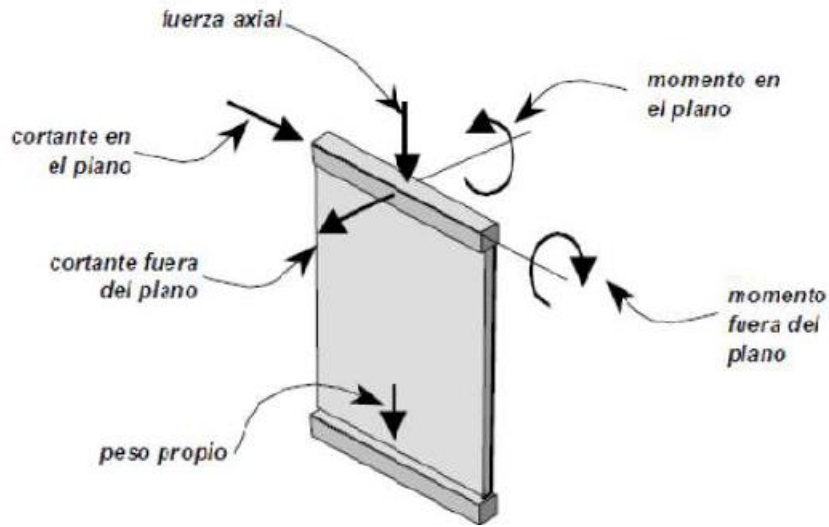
Fuerzas actuantes en un muro estructural.
